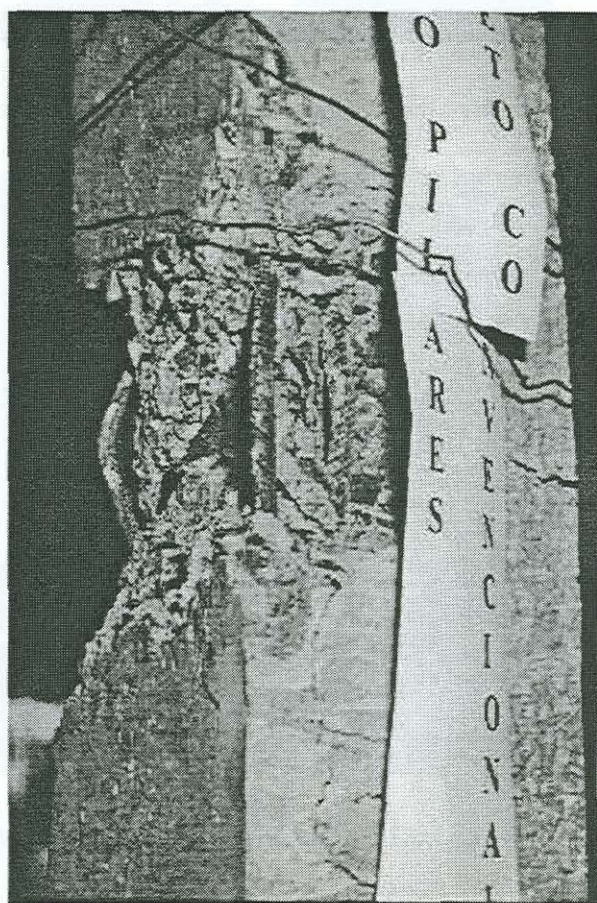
Flambagem das armaduras do núcleo e do reforço do pilar reforçado com concreto armado nas 4 faces.
